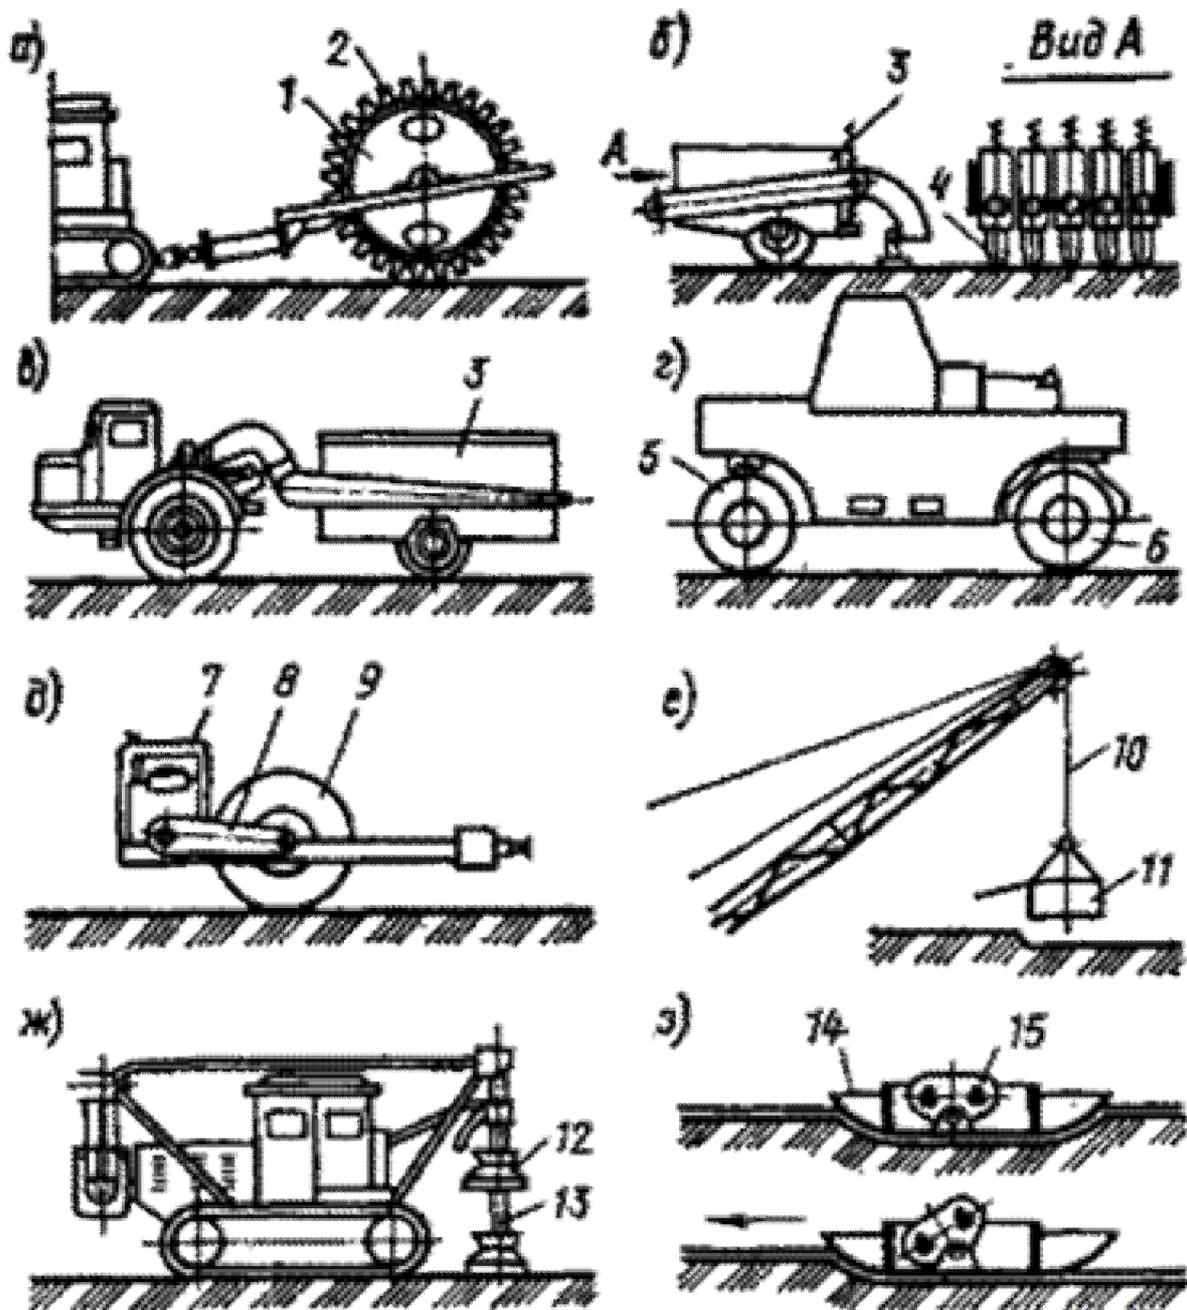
Схемы машин для уплотнения грунтов и дорожных покрытий:
